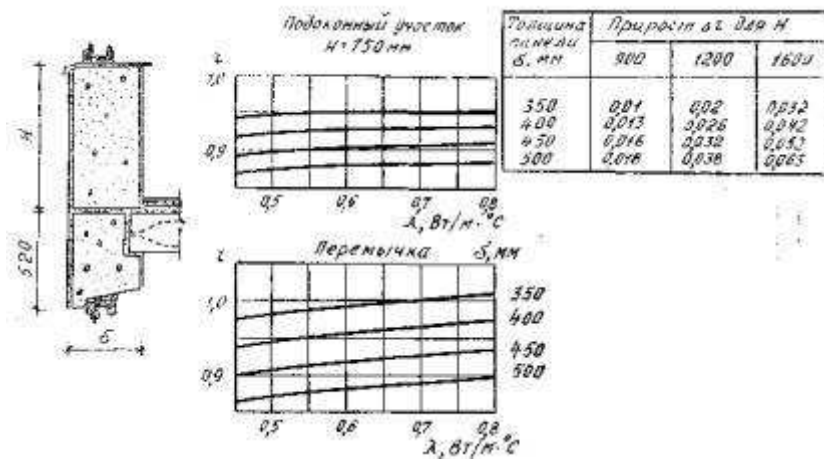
Определение r подоконного участка и надоконной перемычки стеновой панели с горизонтальным стыком без утеплителя и с отдельным оконным блоком (с плитой перекрытия $\delta n = 220$ мм)
